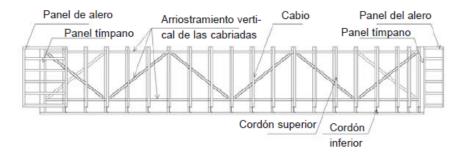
Vista lateral de estructura de cubierta mostrando arriostramiento vertical en sistema de cabriadas. Fuente: (Alacero, 2014).
